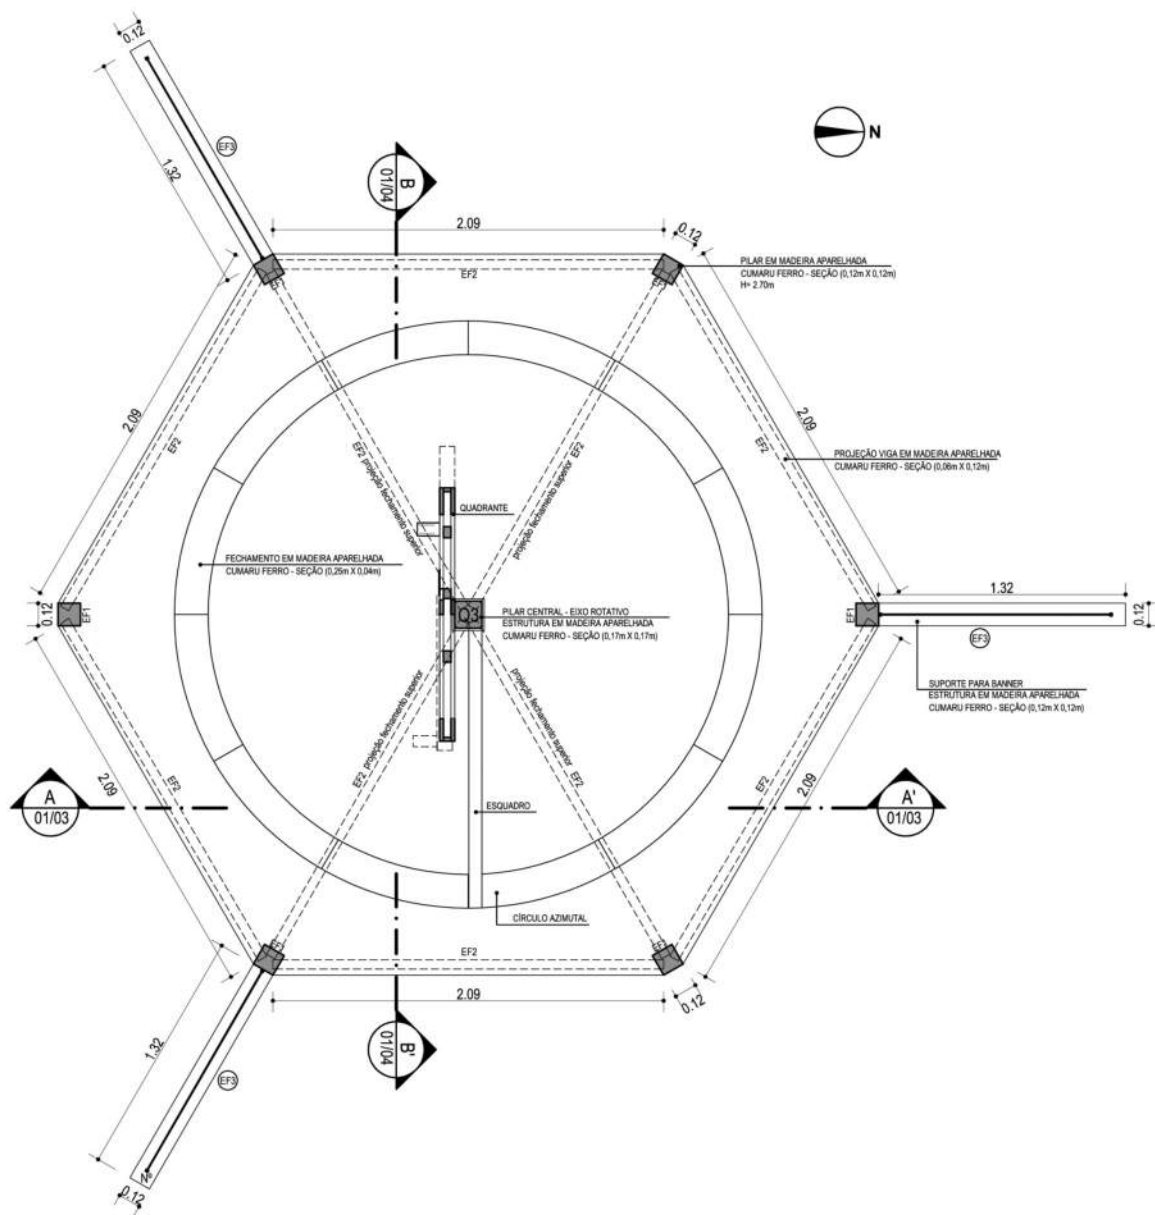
Planta baixa do quadrante, juntamente com o círculo azimutal e o sistema estrutural, elaborada em Auto-Cad. Fonte: SPT/MAST
